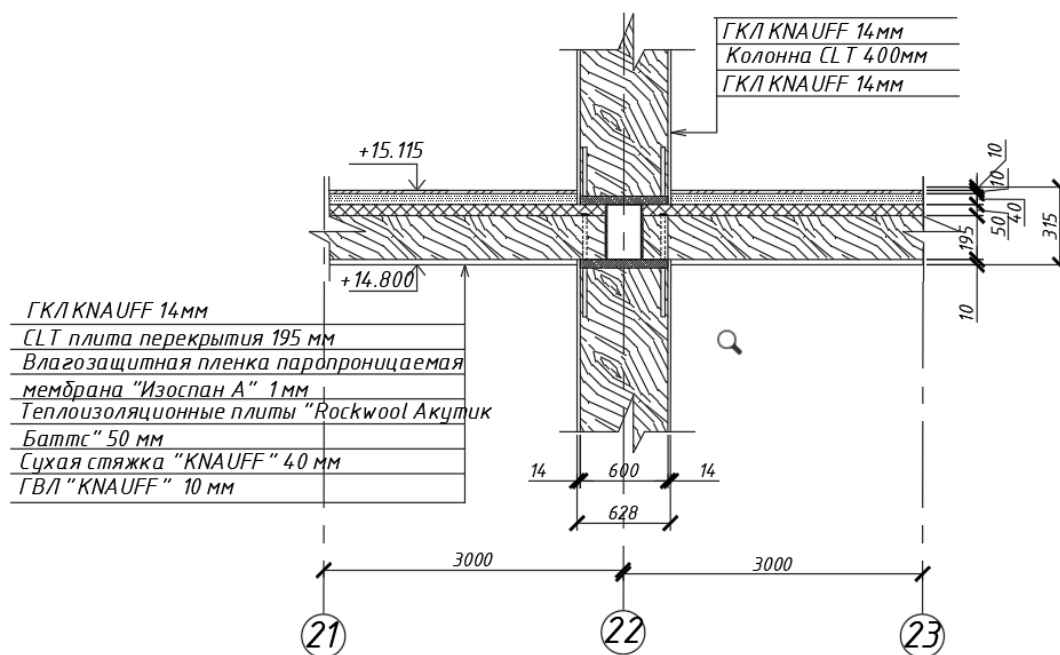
Узел сопряжения плиты перекрытия на колонну
